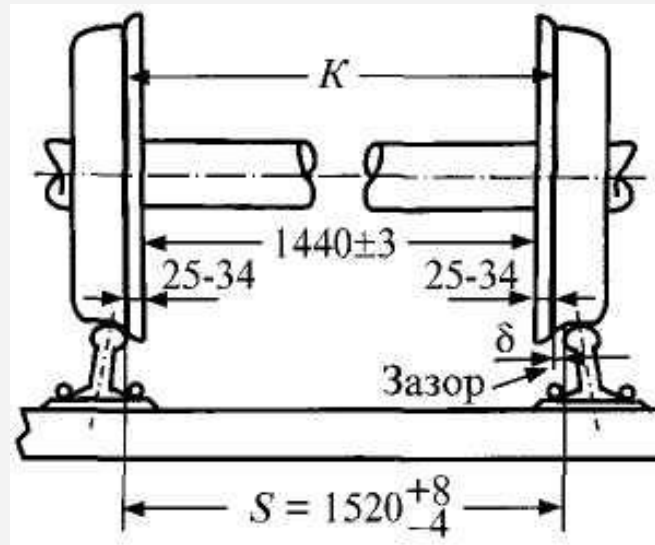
Соотношение размеров и допусков колесной пары или ширины колеи
